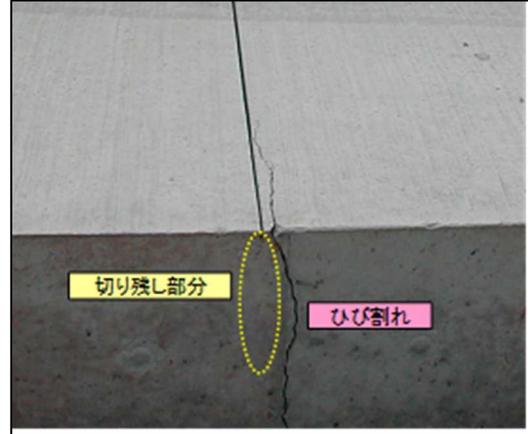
カッタ切断時の切り残しによるひび割れ
